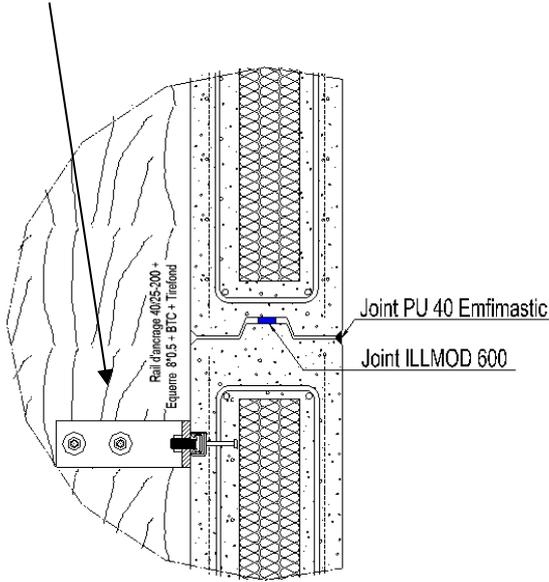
Façades de quai pour bâtiments industriel – coupe verticale – fixation sur poteau bois
